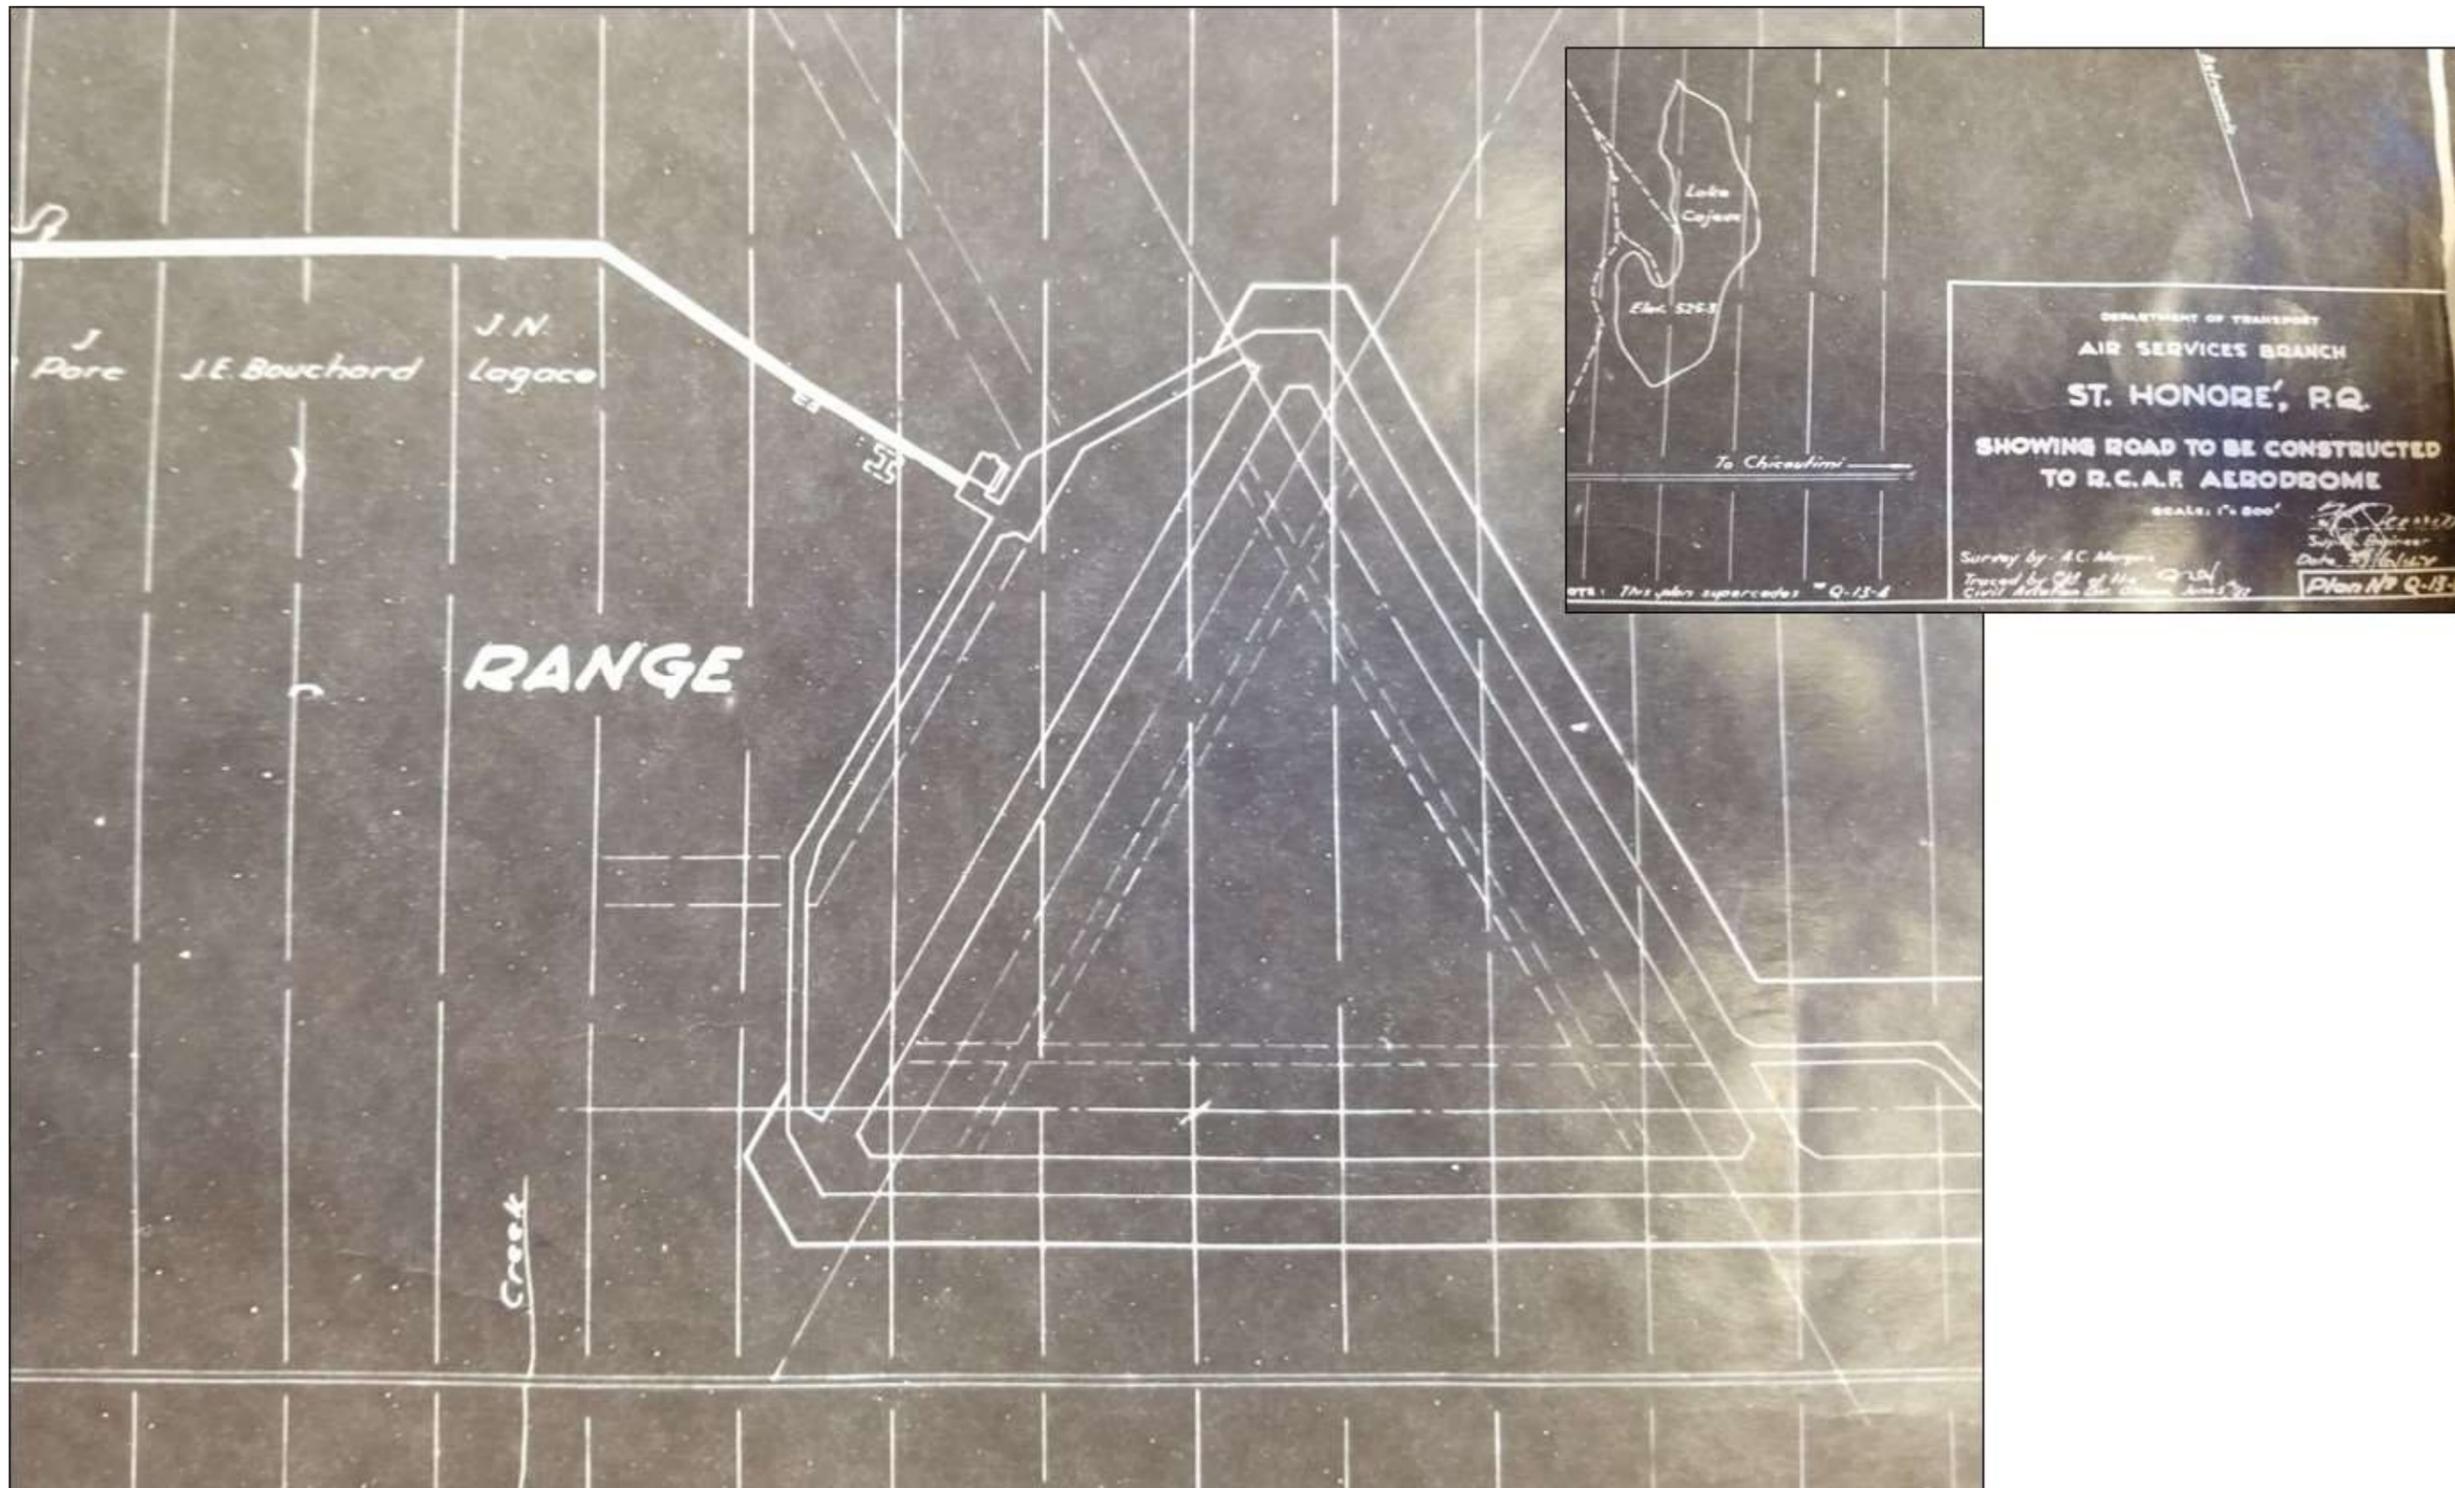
Extrait d'un plan de l'Air Services Branch, indiquant la portion du chemin vers le village situé sur le site de l'aéroport. (Source: Air Services Branch, St Honoré, P.Q. Showing Road to be Constructed to R.C.A.F. Aerodrome, Q-13-4, June 5th/42, Défense nationale, direction de l'aéroport de Saint-Honoré)
